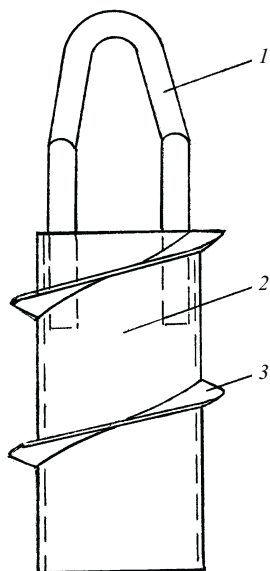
Винтовой анкер сварной – ВАС (узколопастный):
